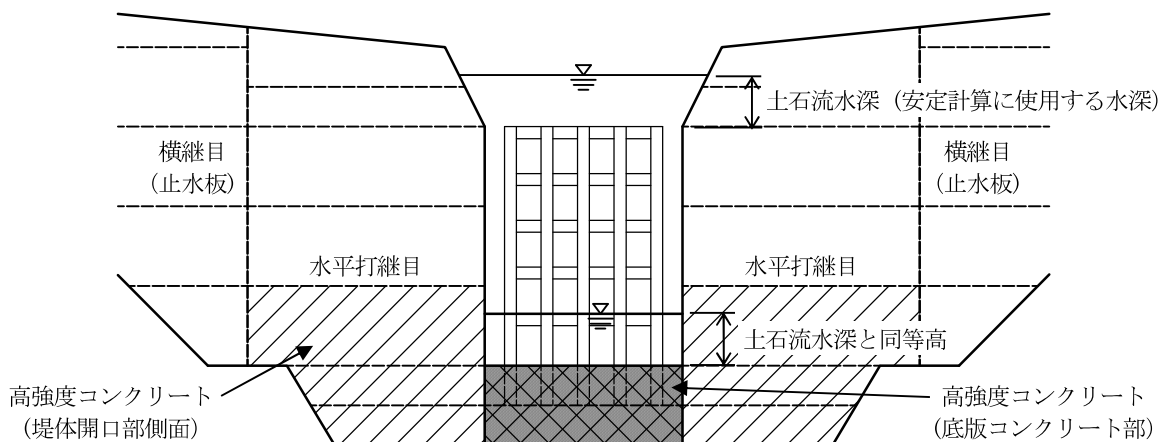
開口部の高強度コンクリートの範囲（透過型砂防堰堤の場合）
